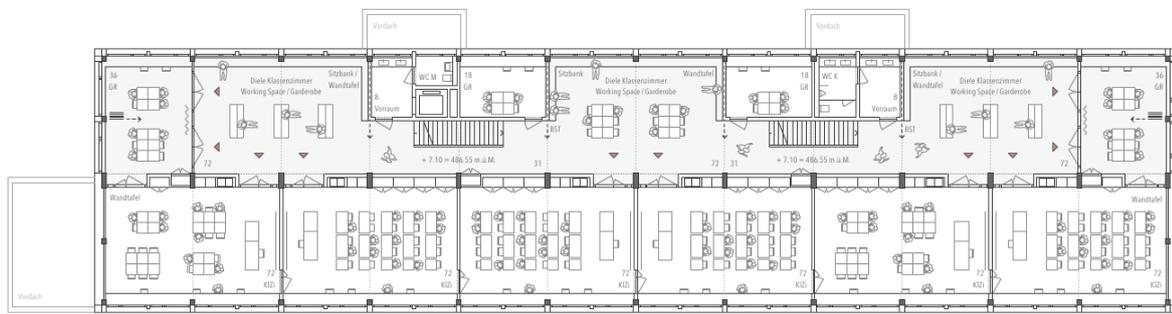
Neubau Sekundarschule, Grundriss 2. Obergeschoss
